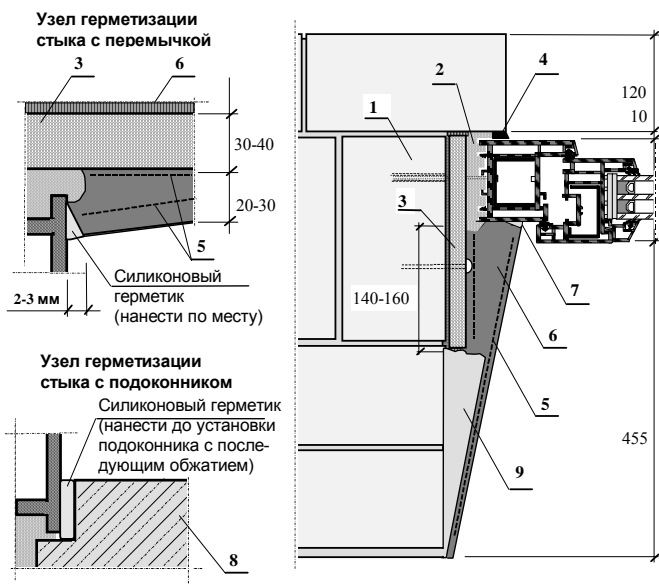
Пример установки оконного блока из ПВХ-профилей в проеме кирпичных стен реконструируемого здания при глубокой нише от старой коробки: 1 - кирпичная кладка; 2 - монтажная пена; 3 - пенополистирол; 4 - предварительно-сжатая уплотнительная лента «illbruck»; 5 - армирующая сетка; 6 - цементно-латексный раствор; 7 - силиконовый герметик; 8 - подоконник; 9 - старая штукатурка
